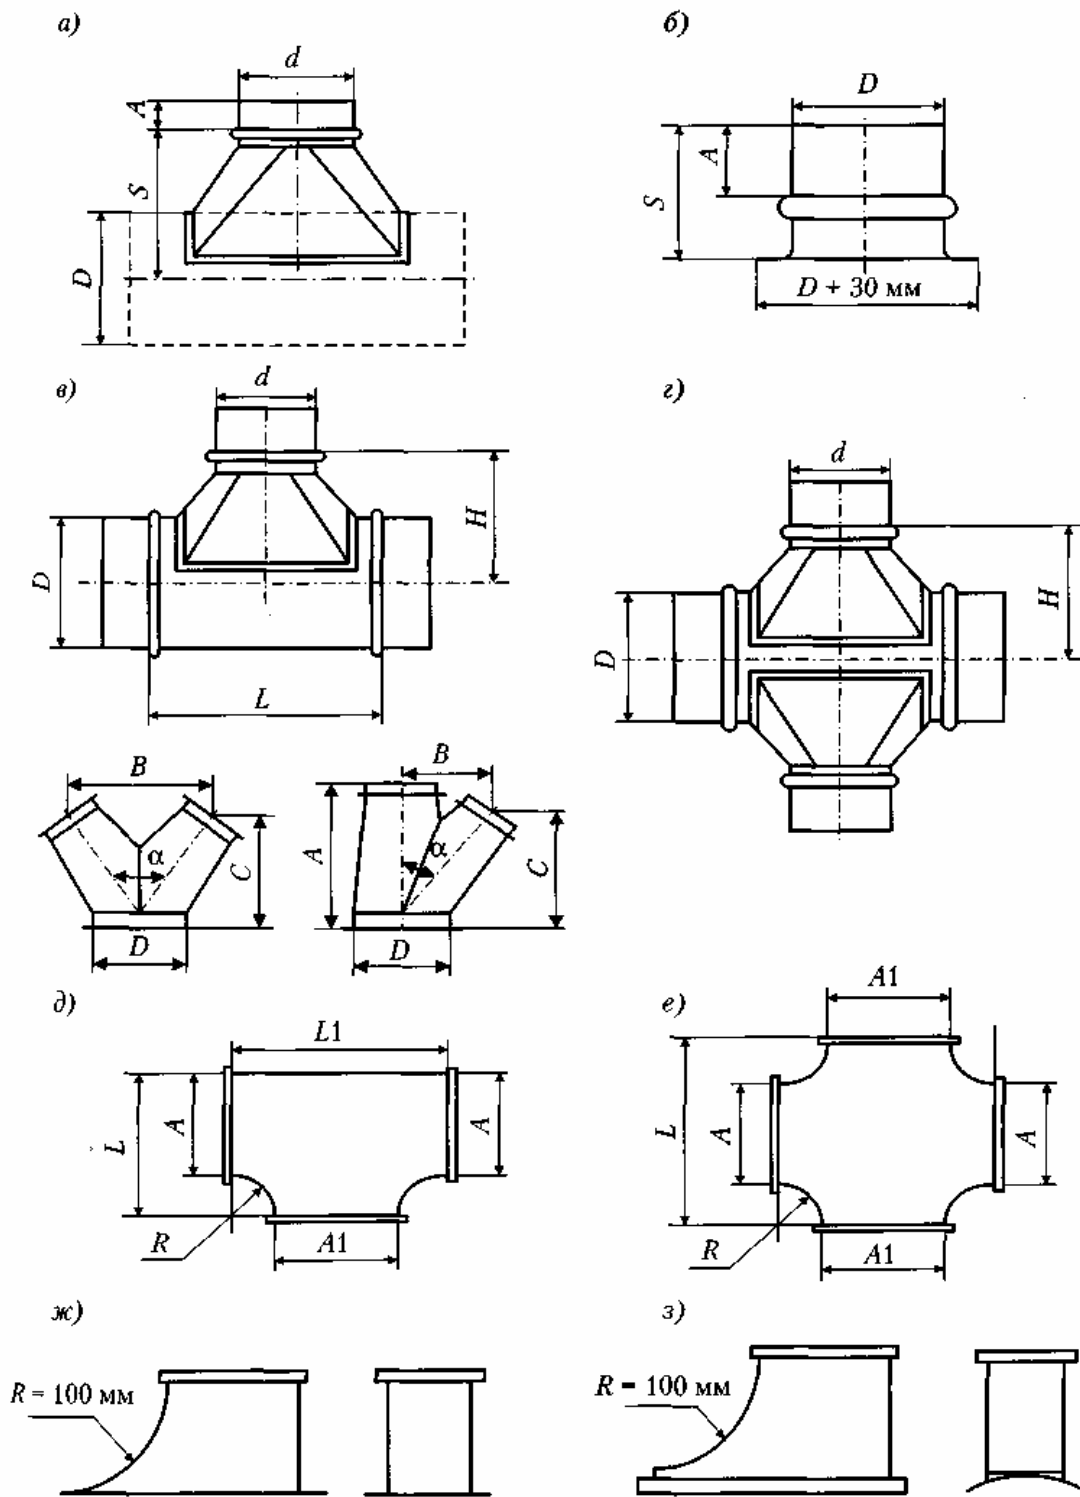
Унифицированные узлы ответвлений: а — врезка круг в круг; б — врезка круг в прямоугольный воздуховод; в — тройники круглые; г — крестовина круглая; д — тройник прямоугольный; е — крестовина прямоугольная; ж — врезка прямоугольная в прямоугольную; з — врезка прямоугольная в круглую
